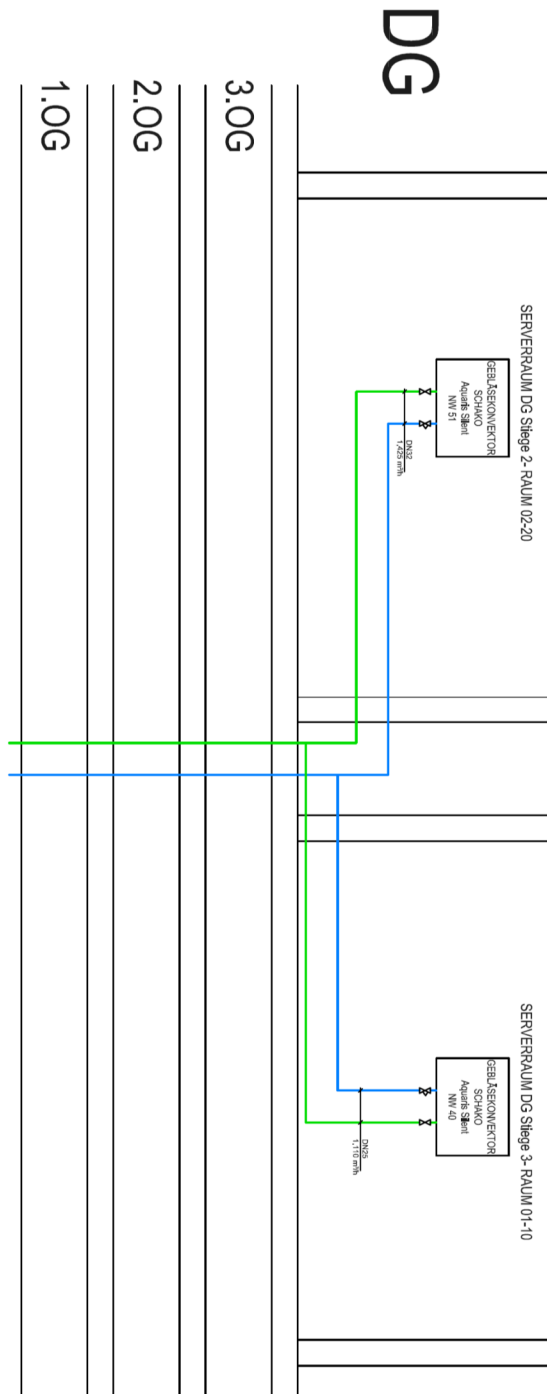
Schematische Darstellung der Anlagenteile im Dachgeschoss
